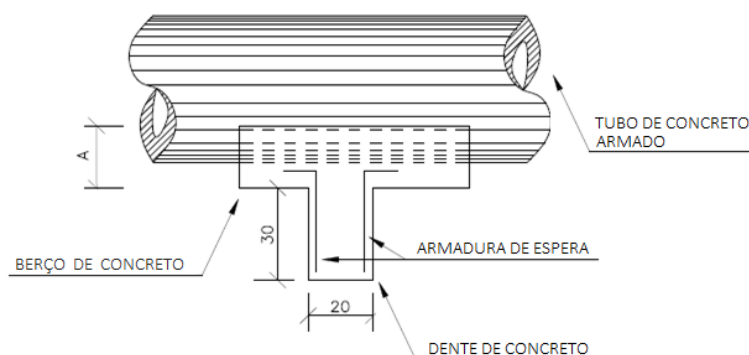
Vista lateral do corpo do bueiro tubular de concreto
